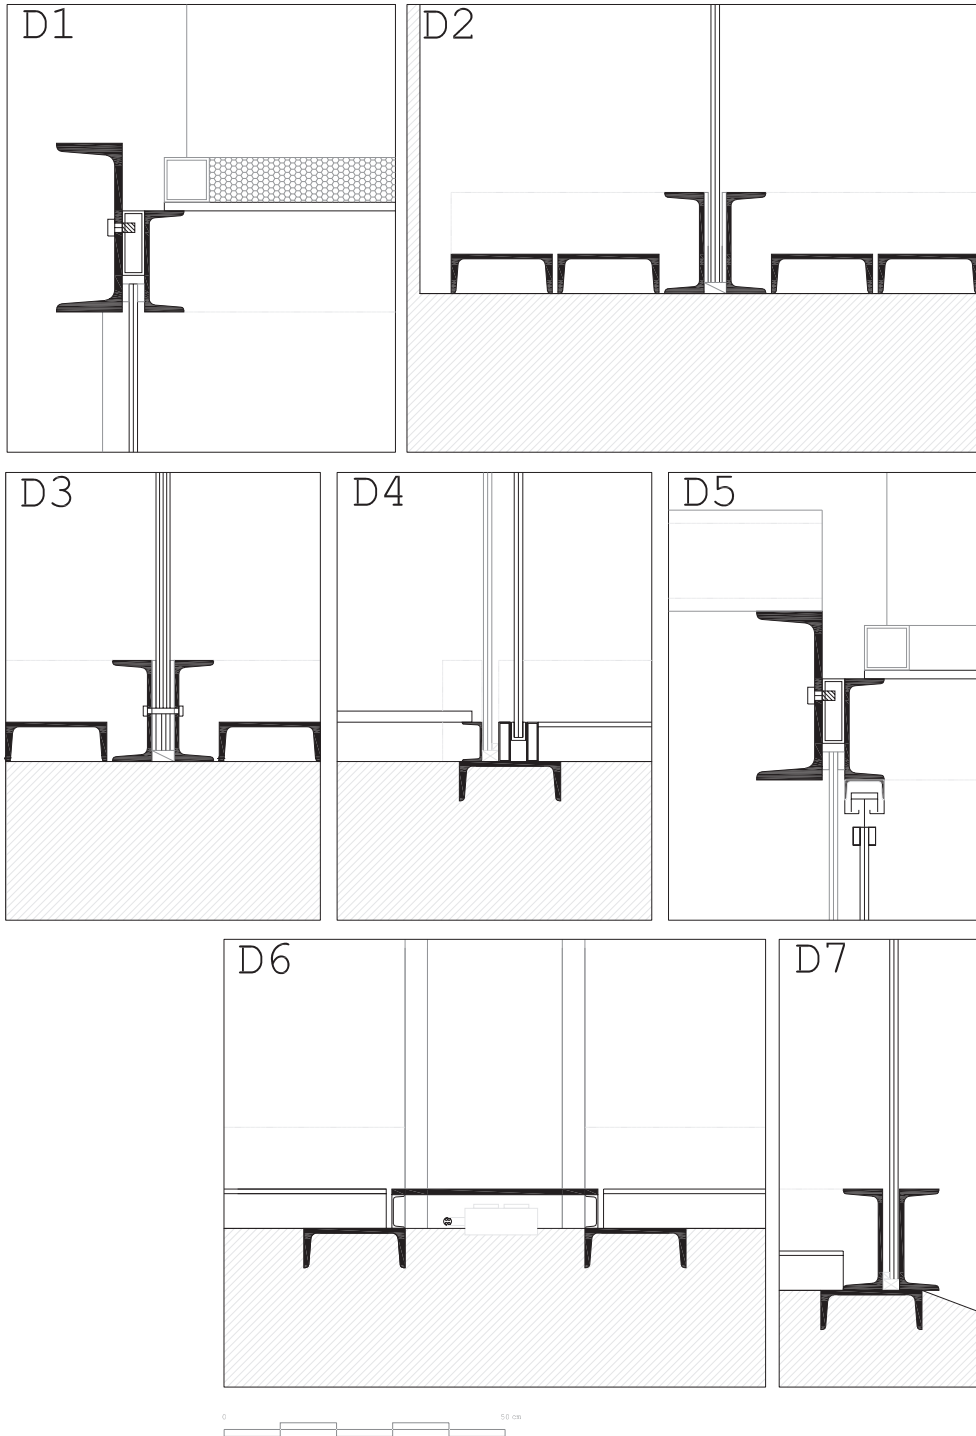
\_detalles constructivos en Intermediae. Imágenes cedidas por el autor Arturo Franco.
